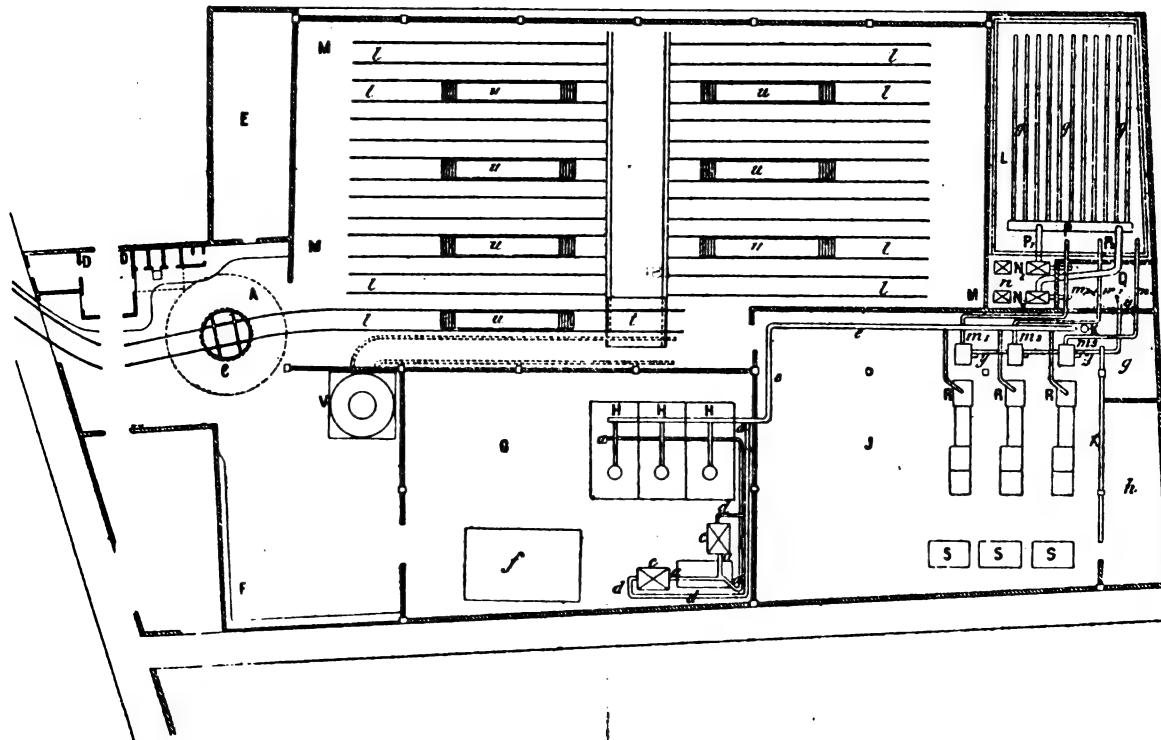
Plan de l'usine et du dépôt des Lilas du tramway Claret et Vuilleumier.
